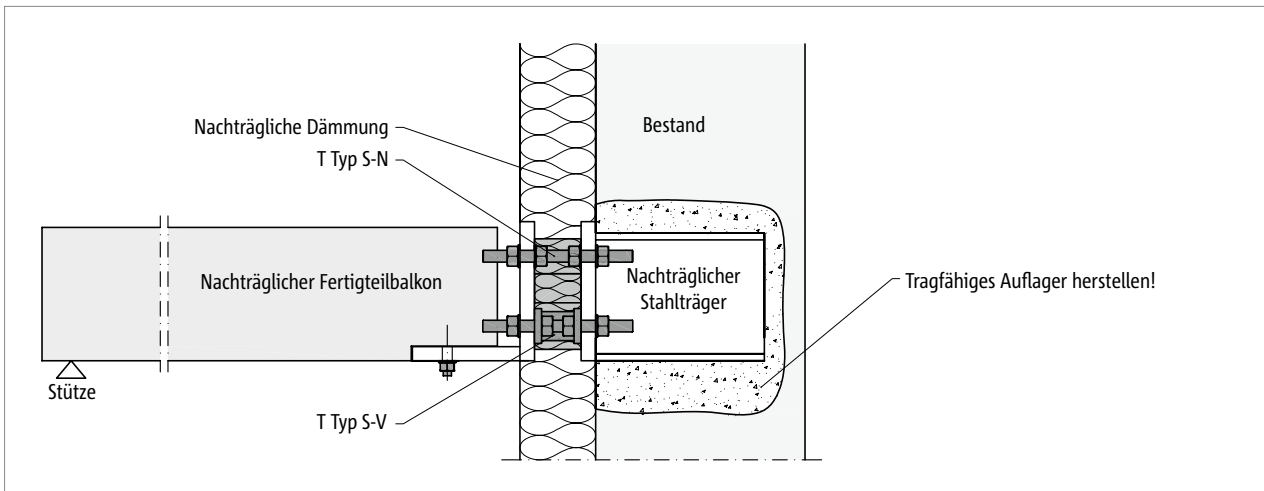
Schöck Isokorb® T Typ S-N und T Typ S-V: Nachträglicher Fertigteilbalkon gestützt; angeschlossen an nachträglich eingebauten Stahlträger
